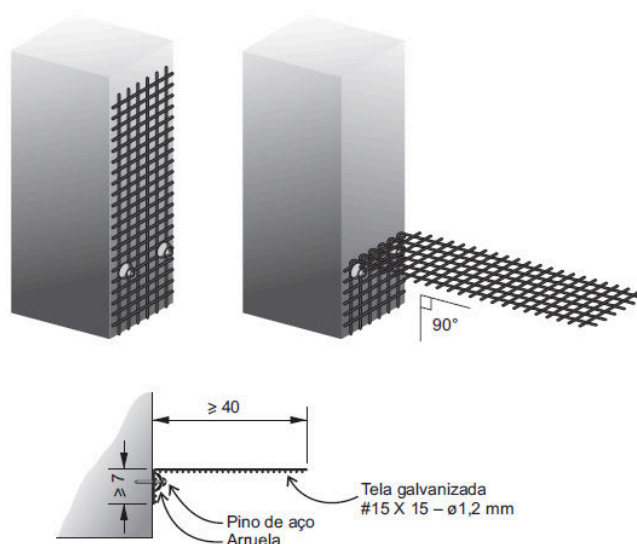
Fixação entre alvenarias e pilares com o emprego de tela metálica galvanizada.
